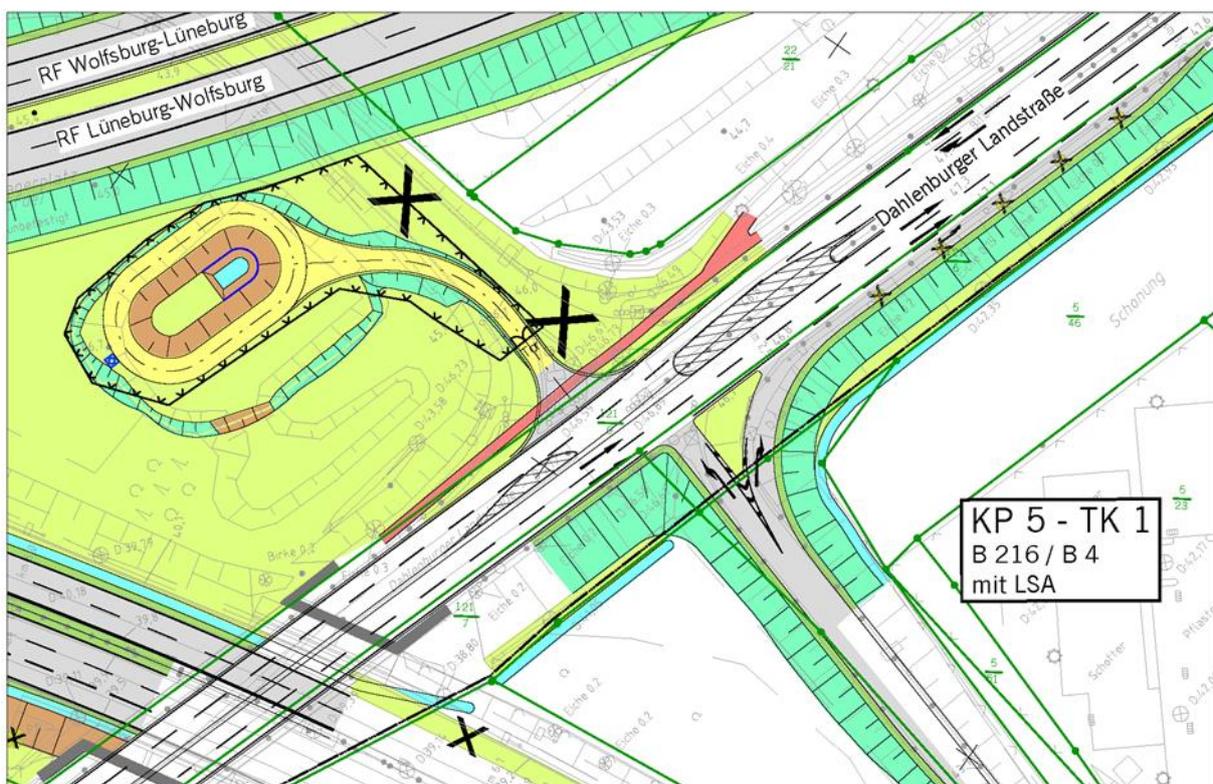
Auszug aus dem Lageplan (Unterlage 5 Blatt 7)
